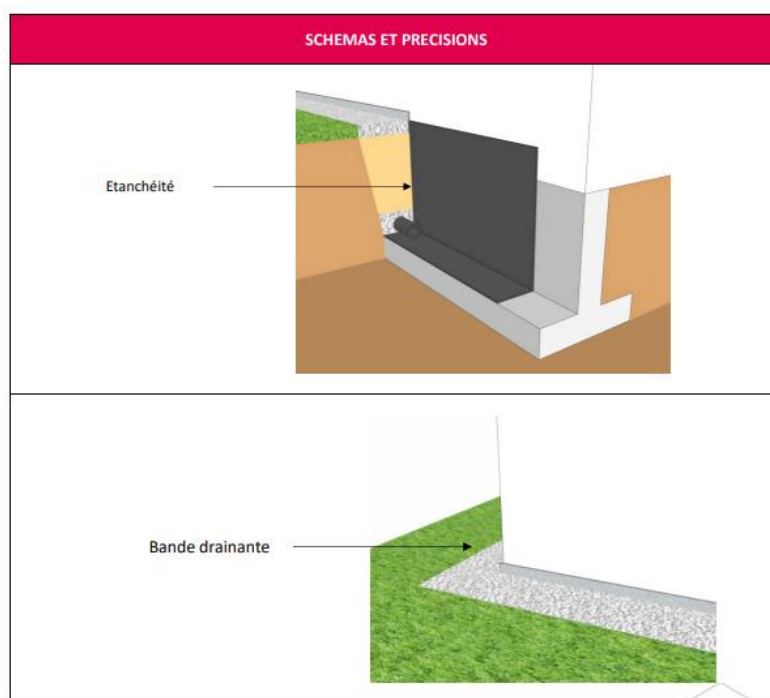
Représentation en 3D des exigences au niveau des fondations du Label logement des hauts Île de La Réunion
